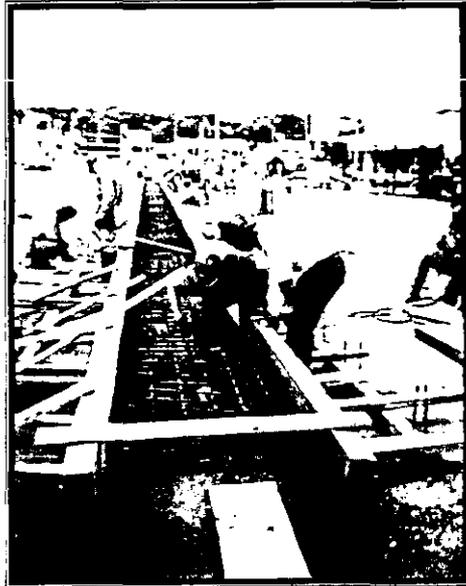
Colado de la plantilla para la colocación del acero de refuerzo en la construcción de la cimentación del estribo.
